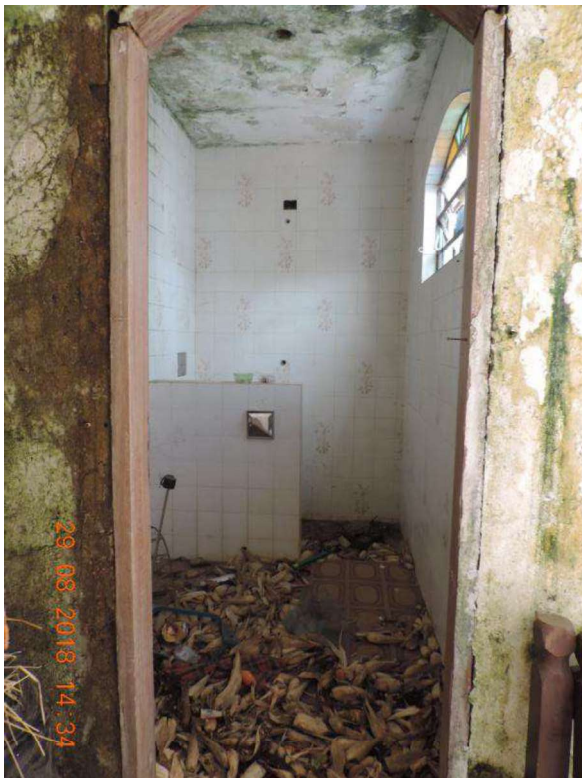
VISTA INTERNA DA CASA SEDE
